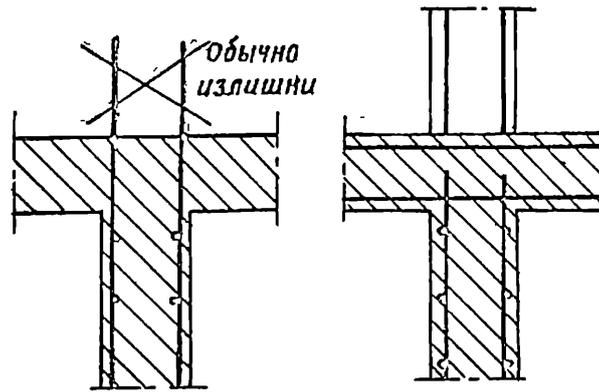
9. Выпуски вертикальных стержней в стенах не нужны, если отсутствует вертикальное растяжение
